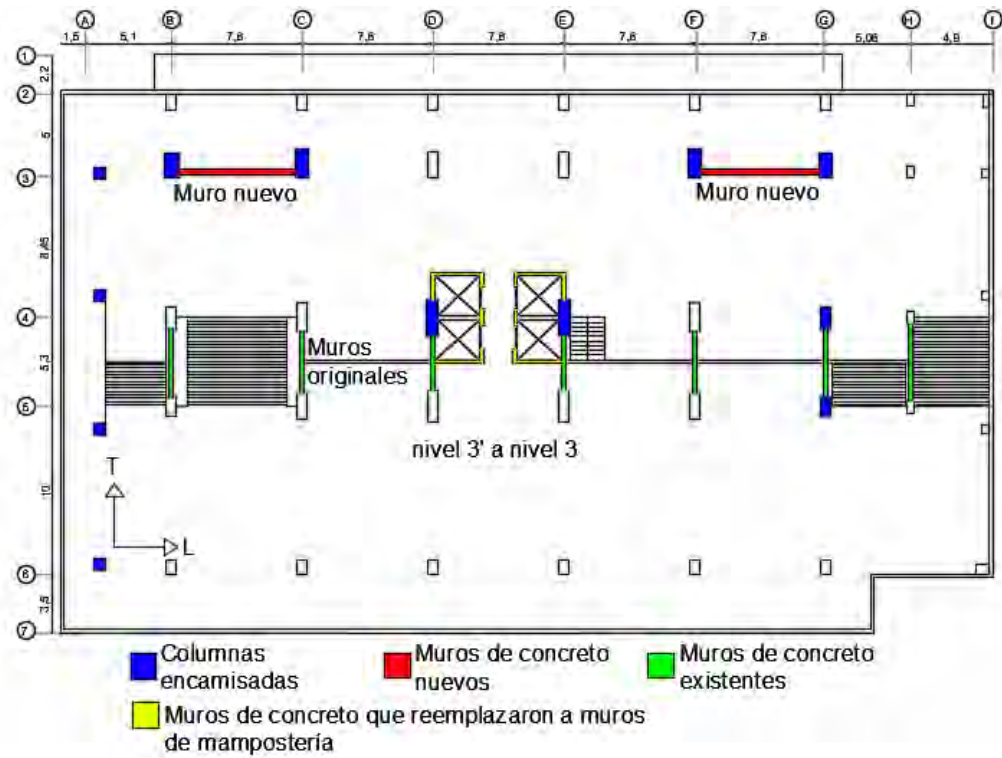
Elementos estructurales reforzados en los niveles 3' y 3
